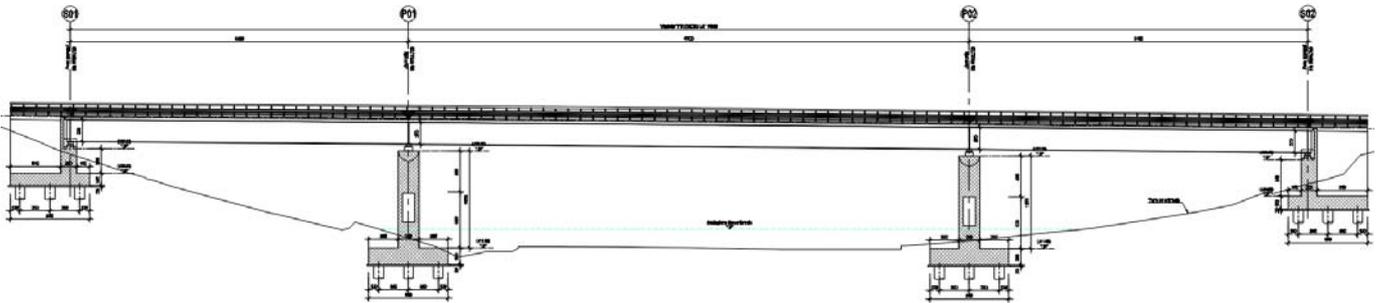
Viadotto Firenzuola – Sezione longitudinale
